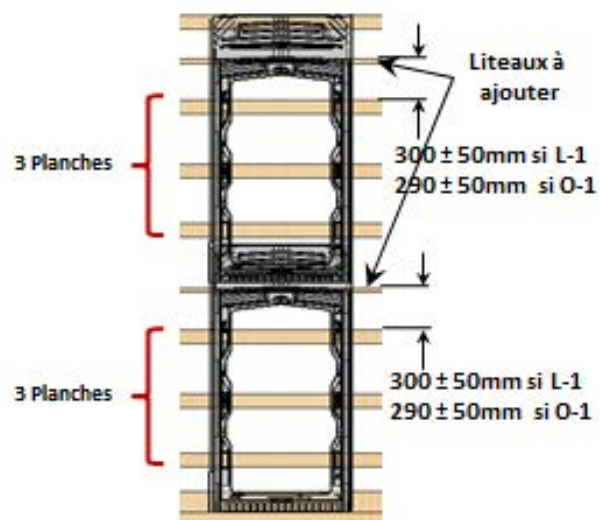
Platelage du champ photovoltaïque avec 6 pattes de fixation par module
